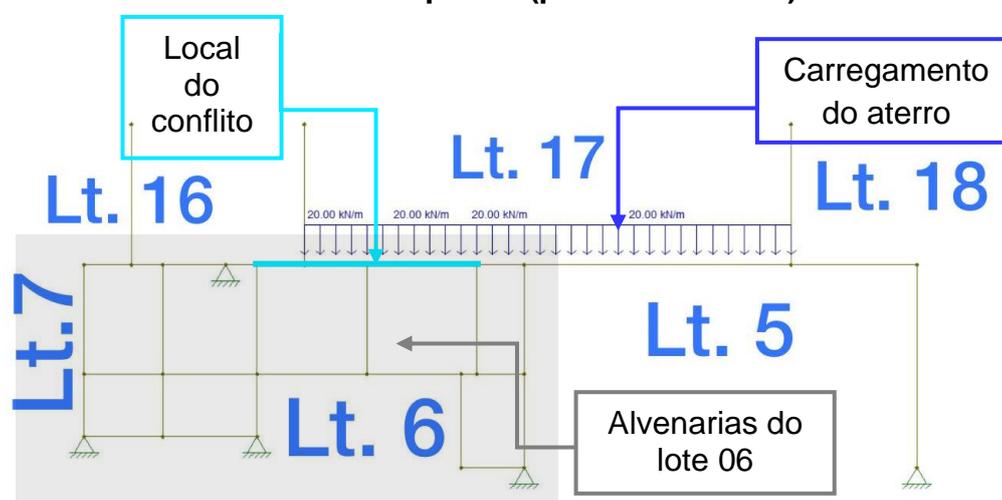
Representação em planta dos eixos das alvenarias do lote 6 e os muros de divisa com o lote 17 no aplicativo FTOOL. Fonte: Autor.
